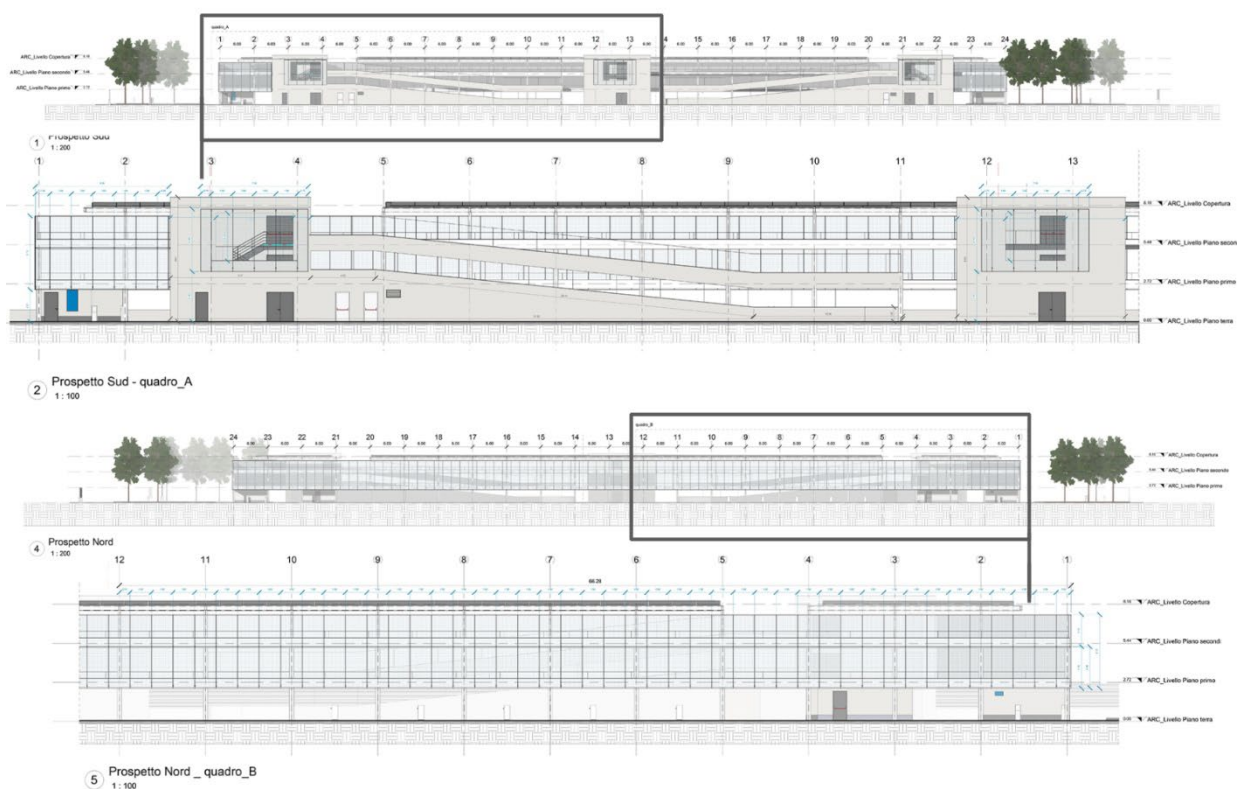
Prospetti del parcheggio multipiano Saliceto
